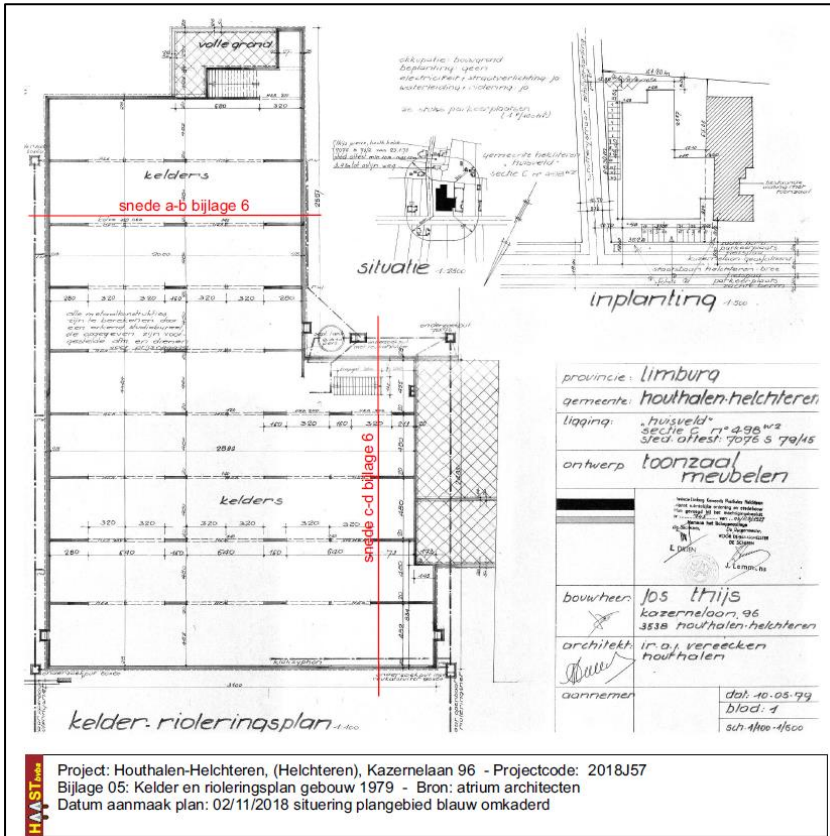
Inplantingsplan, grondplan kelders en rioleringsplan van de uitbreiding uit 1979 © ATRIUM architecten
